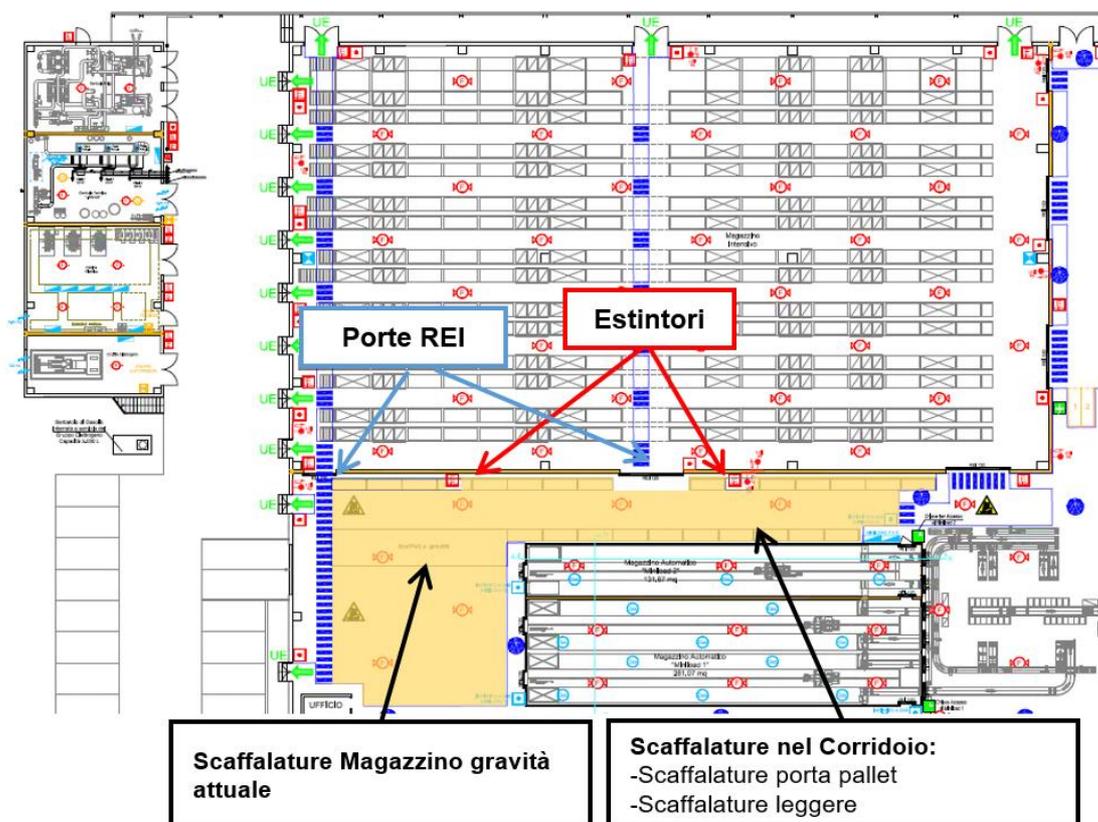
ULC – Sezione della planimetria del magazzino ULC – piano terra
